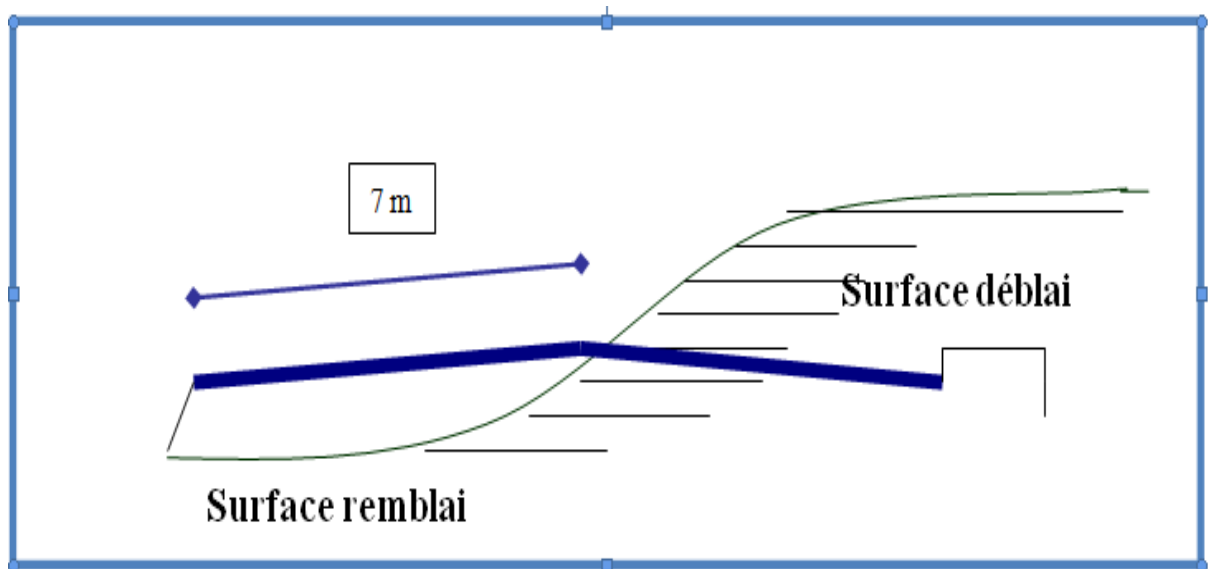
Les sections des profils en travers d'un tracé donné.
